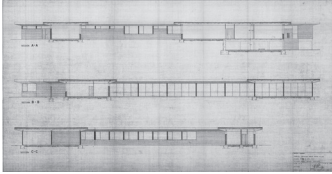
Guardería en el polígono de Coia, Vigo, 1969. Secciones. Archivo COAG Vigo 30/70.
